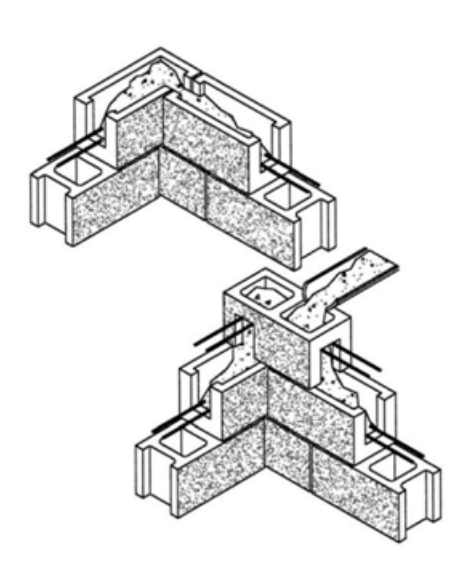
Detalle del suple en los extremos de las barras de refuerzo horizontal (Lane, 2007)
